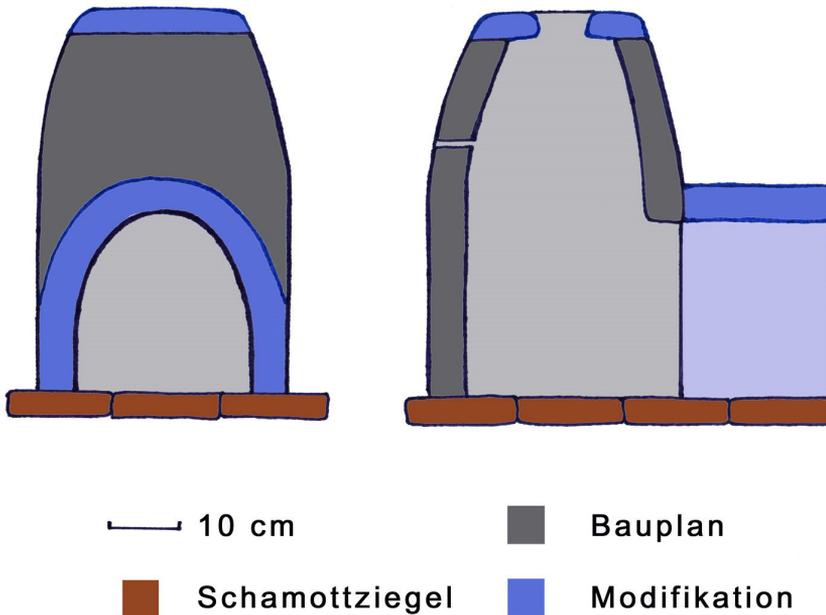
Schnittzeichnung des ersten Perlenofen-Entwurfs PO-Borg-1. Graue Elemente: erster Entwurf; blaue Elemente: Ergänzungen. – Sectional drawing of the bead furnace PO-Borg-1. Grey elements: first layout; blue elements: later additions.
